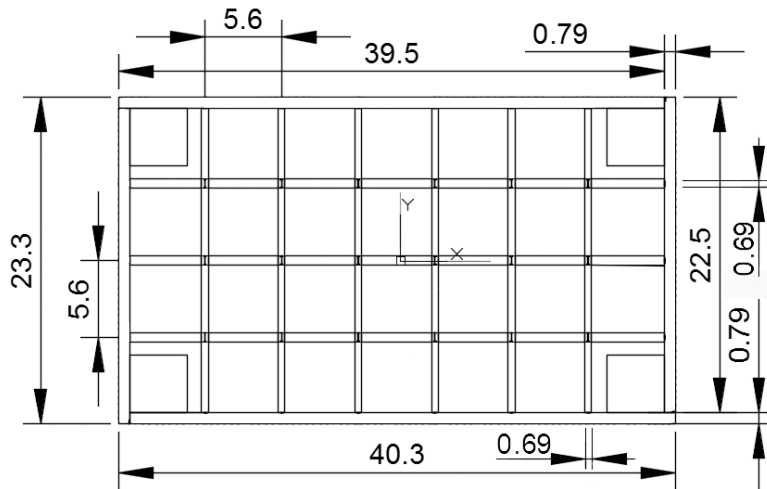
Secção S1 em planta, desenhada em AutoCAD
